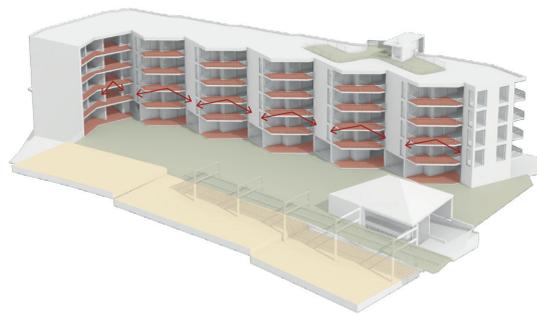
Schema Aussengeschoßflächen gegen den Hof (Quelle: AR3 Architekten).
